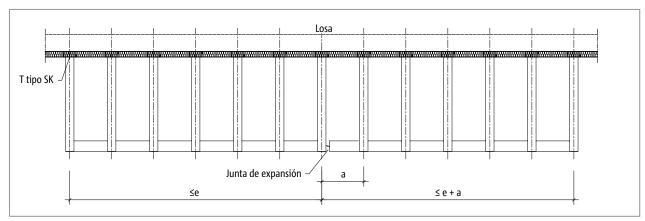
Schöck Isokorb® T tipo SK: Separación máxima de las juntas de expansión e
